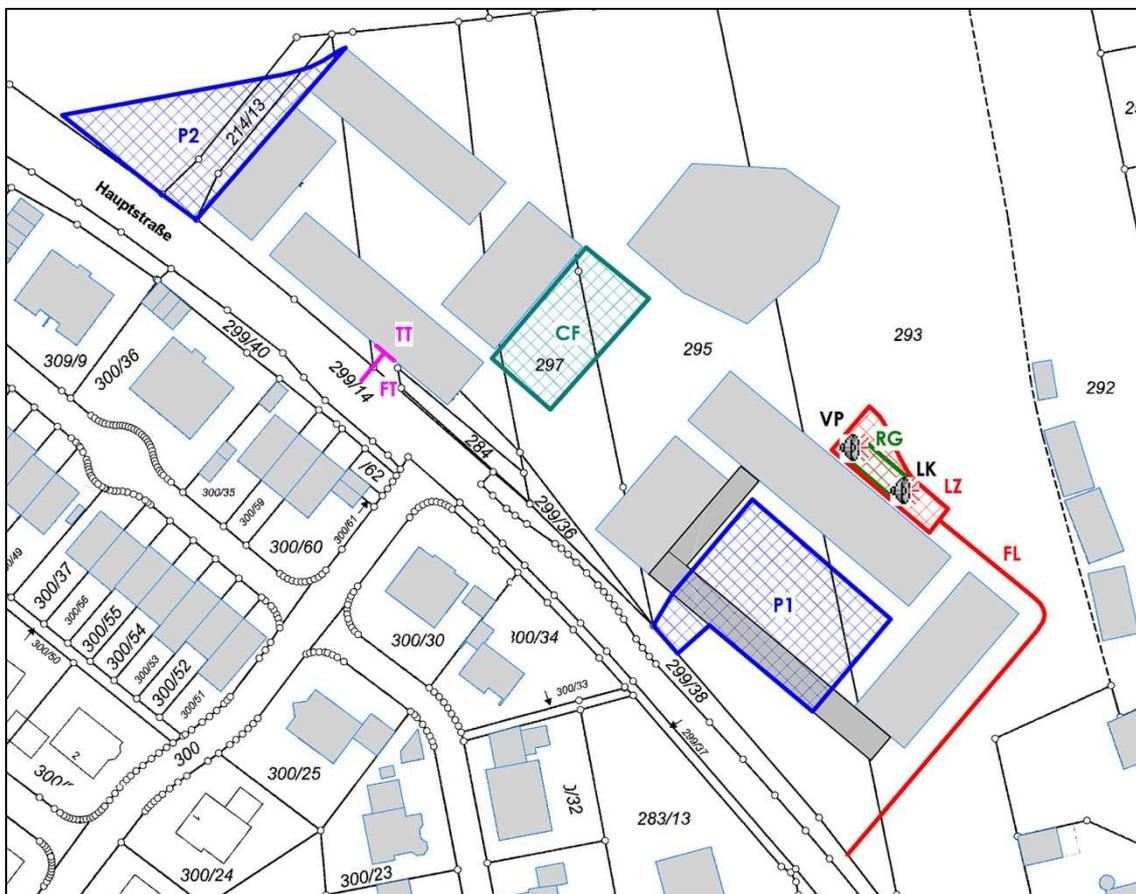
Lageplan mit Darstellung der relevanten Schallquellen
